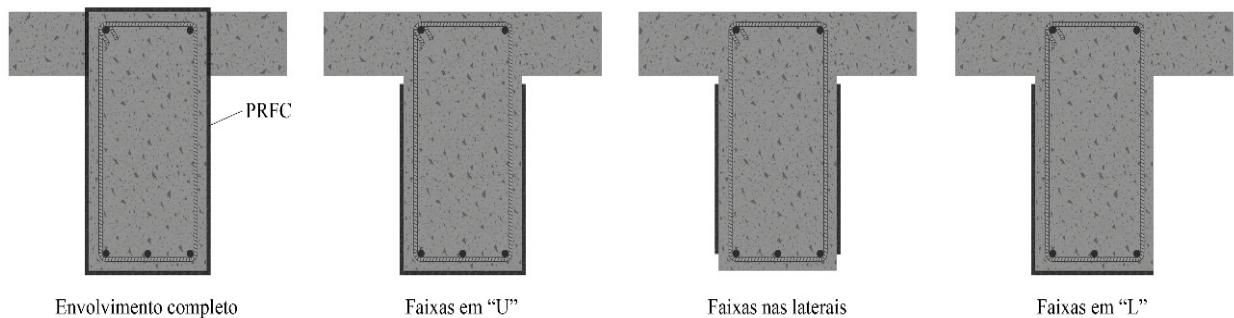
Alternativas de colocação da fibra em vigas, para reforço ao cisalhamento.
